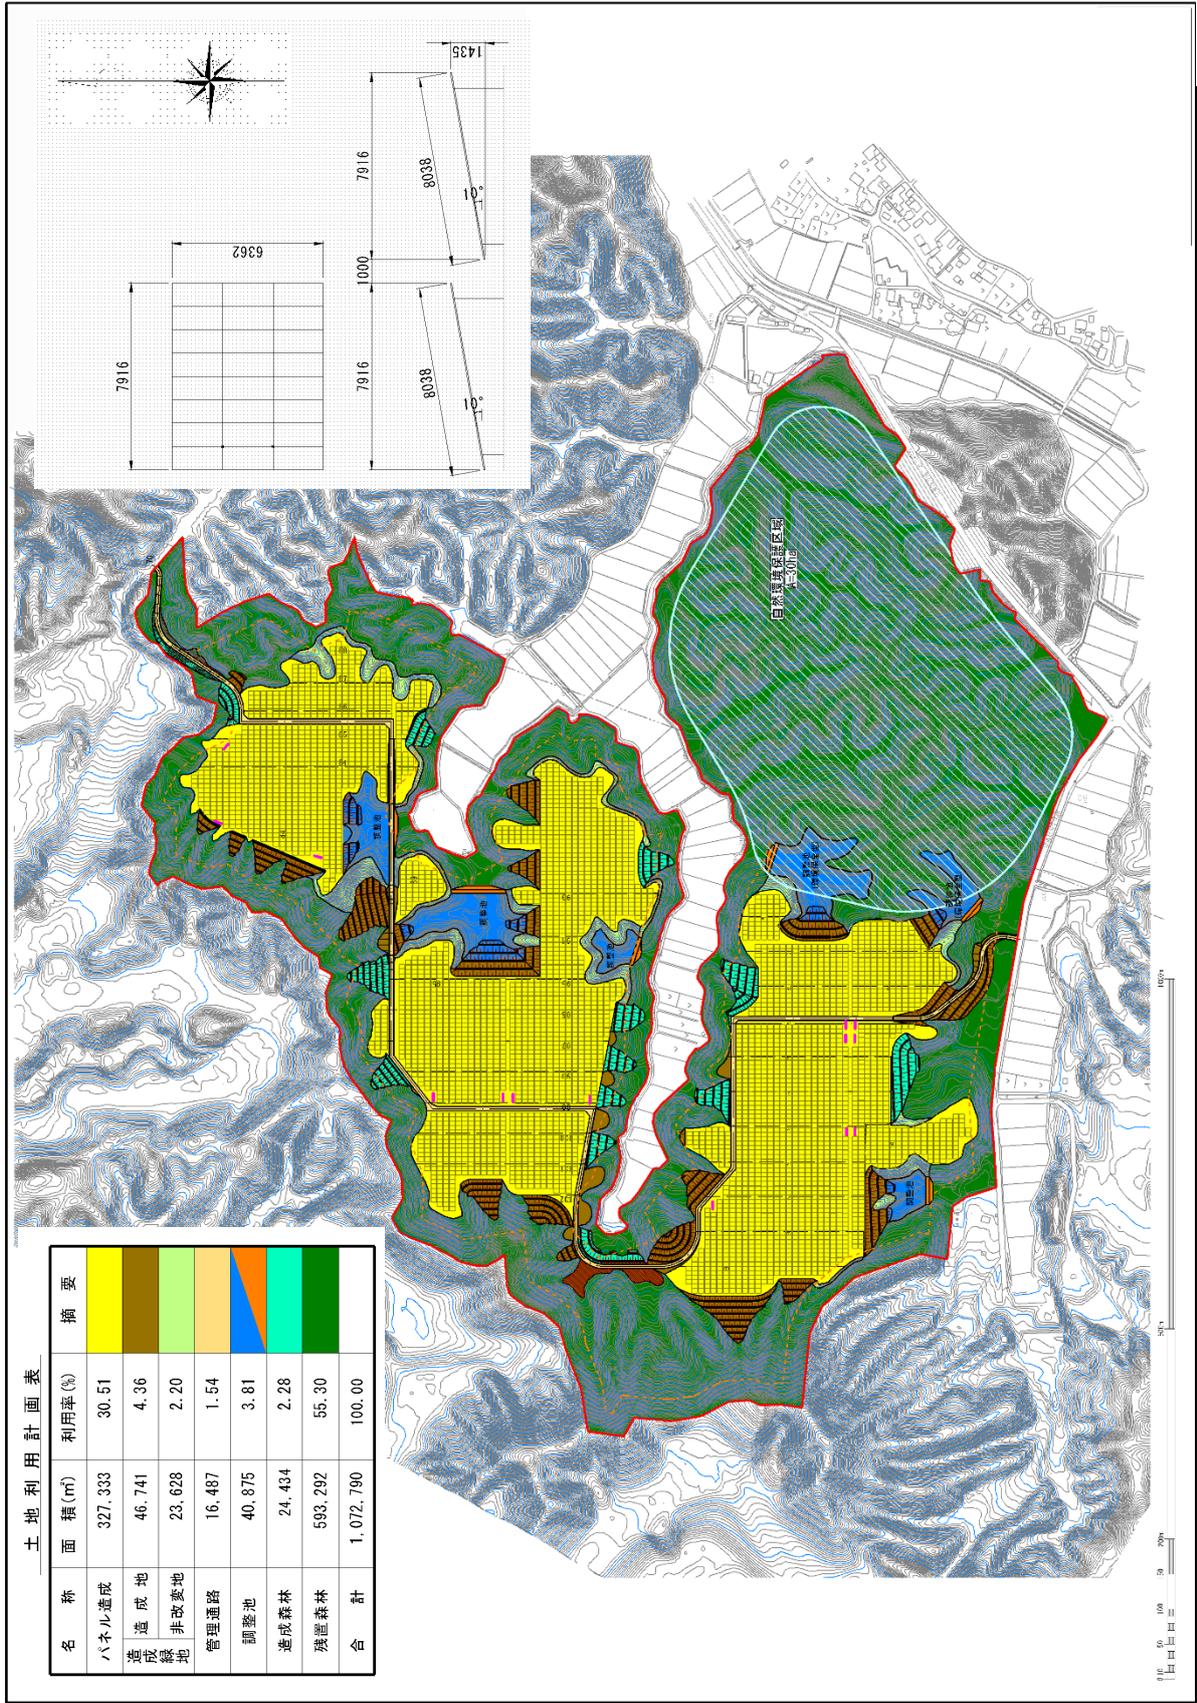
土地利用計画平面図 (評価書時の計画)
